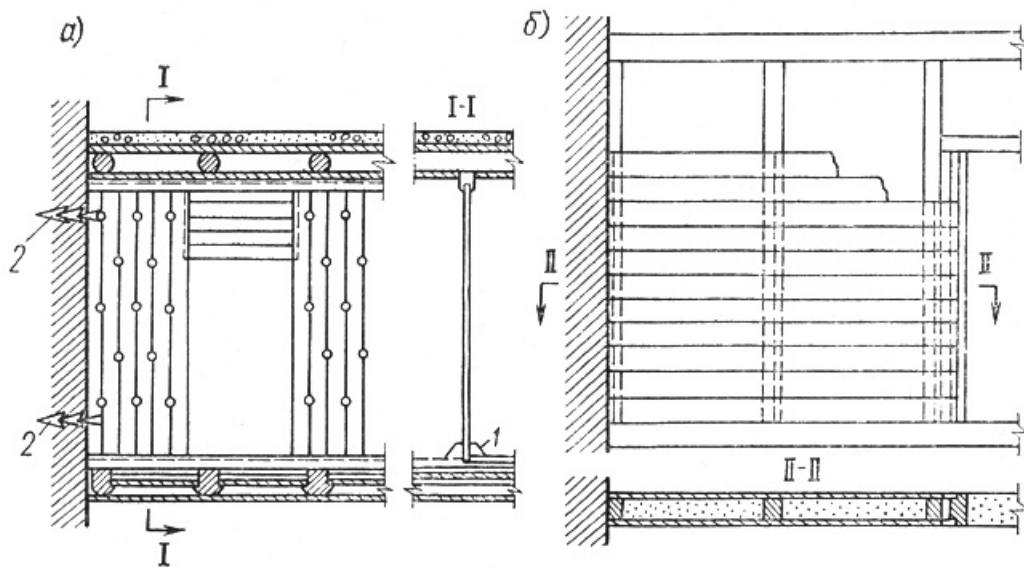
Конструкции разбираемых деревянных оштукатуренных перегородок
